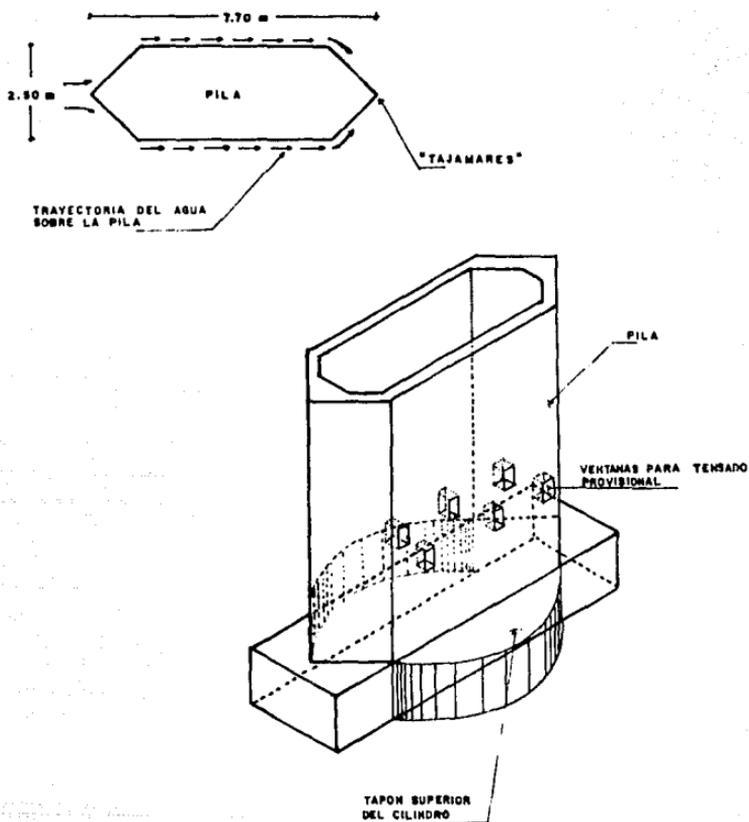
SECCION DE LA SUBESTRUCTURA (PILAS)
